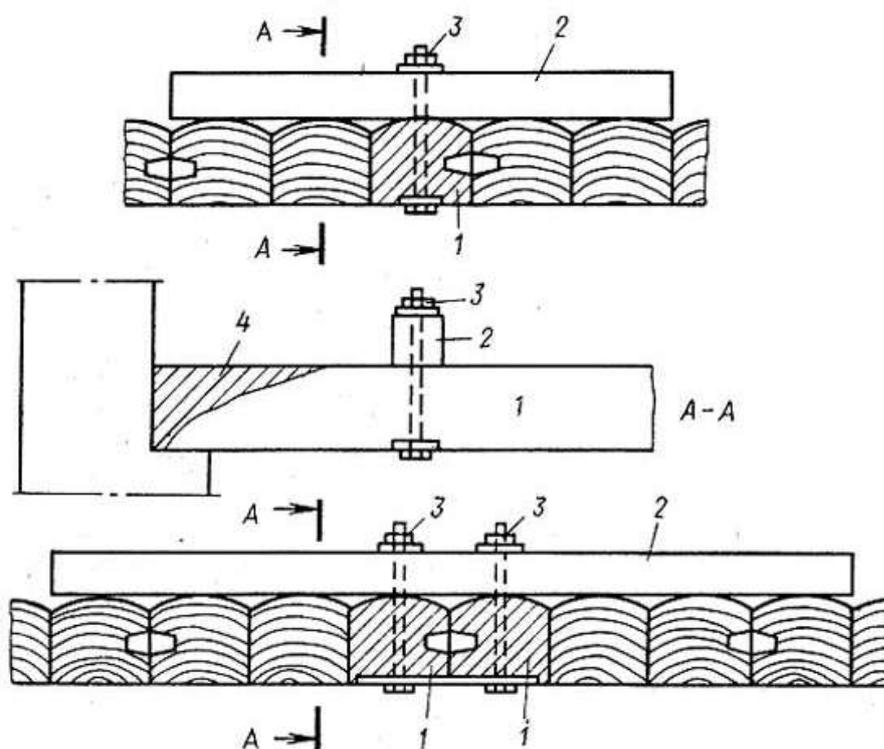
Крепление балочного (на шпонках) перекрытия к прогону болтами:
